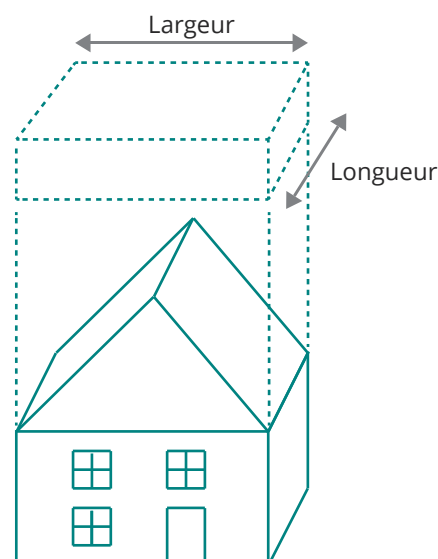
Plan horizontal de la superficie du toit (Source : GIZ/Agire)
